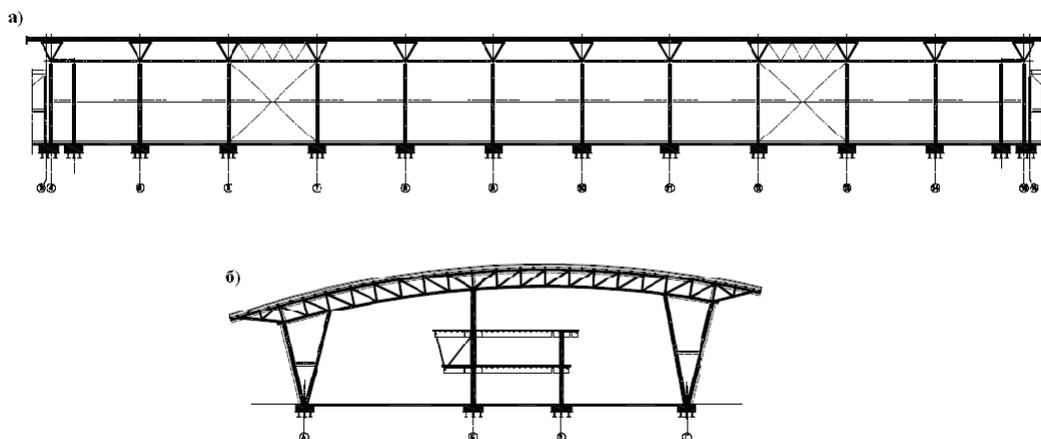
Конструктивная схема здания: а – продольный разрез; б – поперечный разрез
